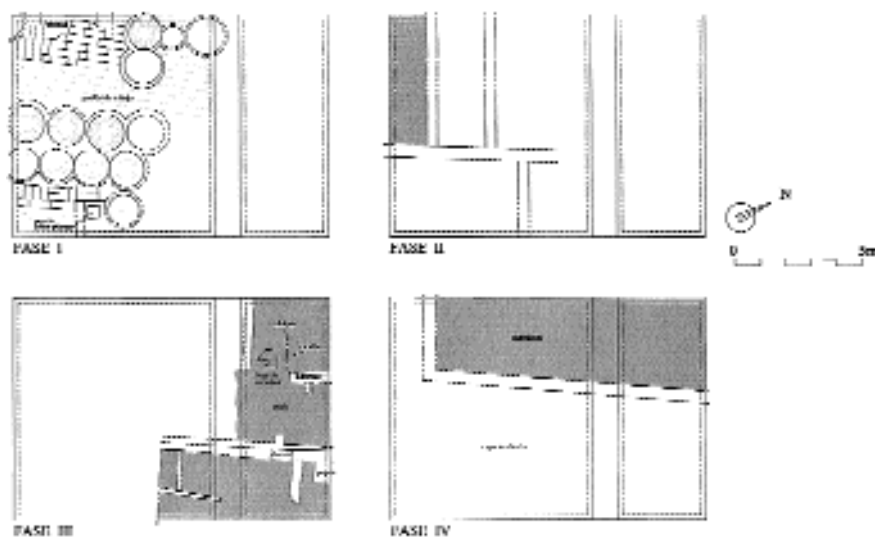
Planta de la tenería de la C/ Santísima Trinidad
